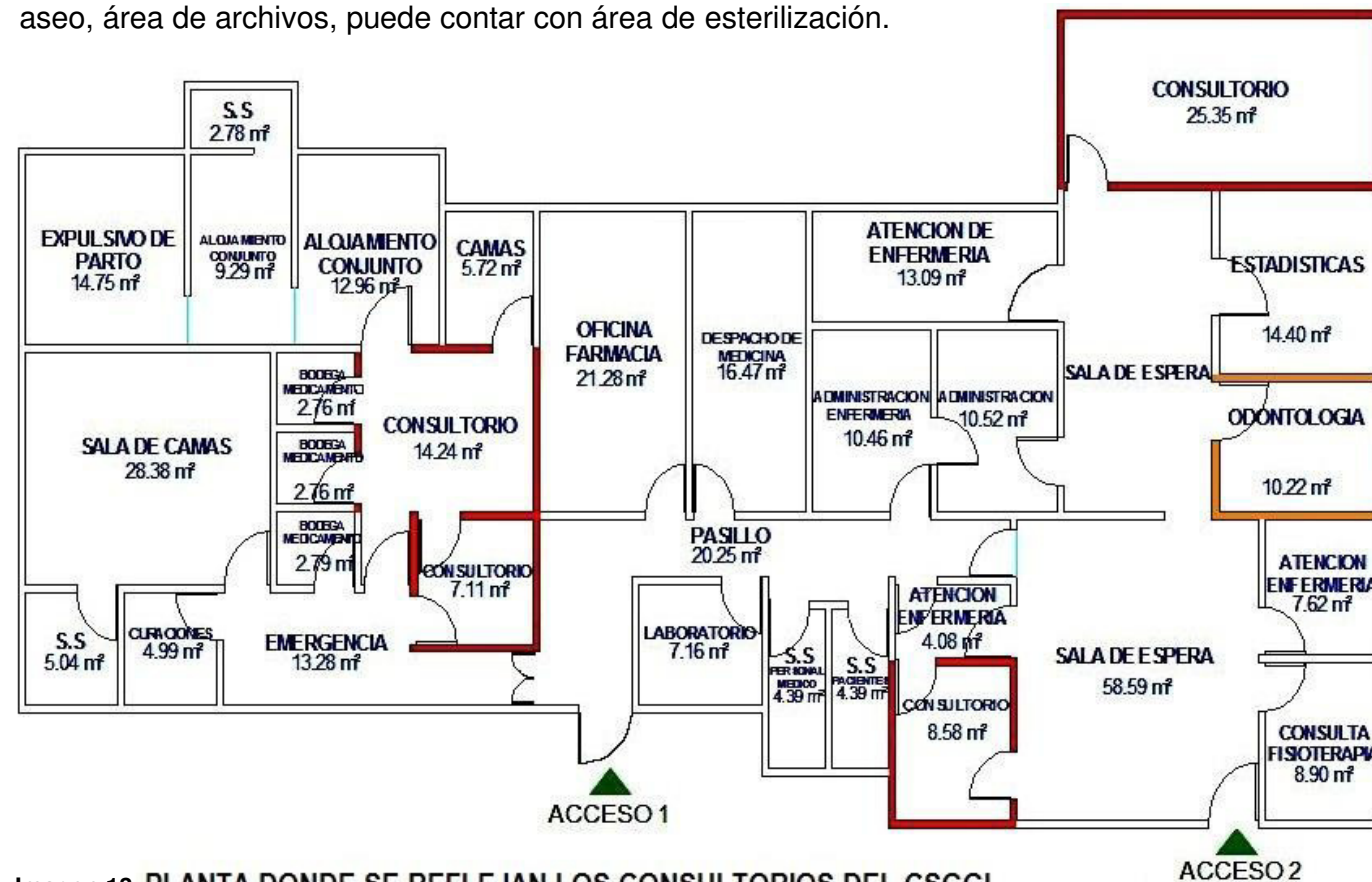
PLANTA DONDE SE REFLEJAN LOS CONSULTORIOS DEL CSGGL
